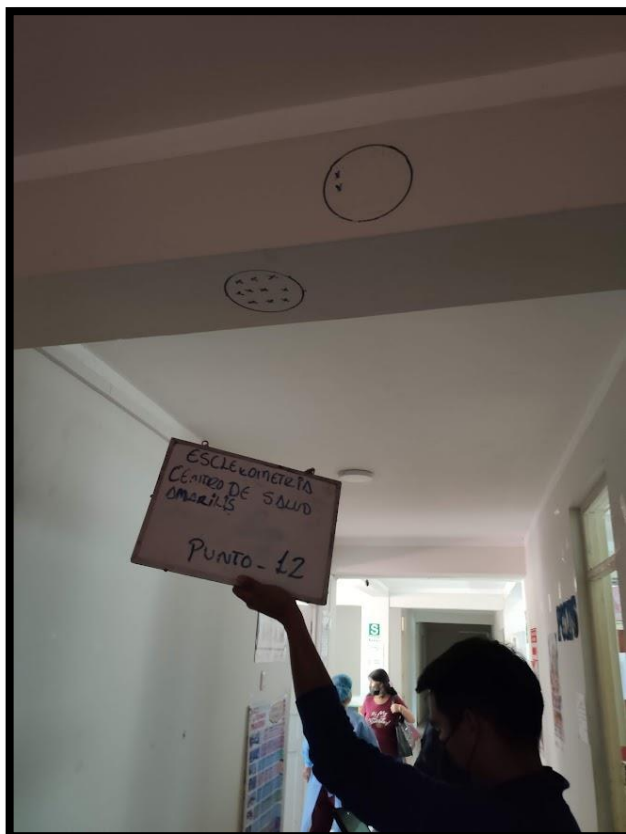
Prueba de esclerómetro en viga del primer nivel del módulo 1.
